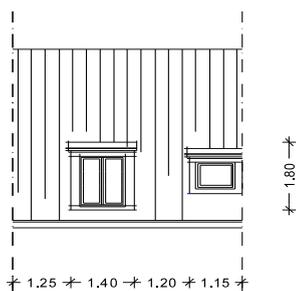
D Gaube Haustyp 8 (straßenseitig)
